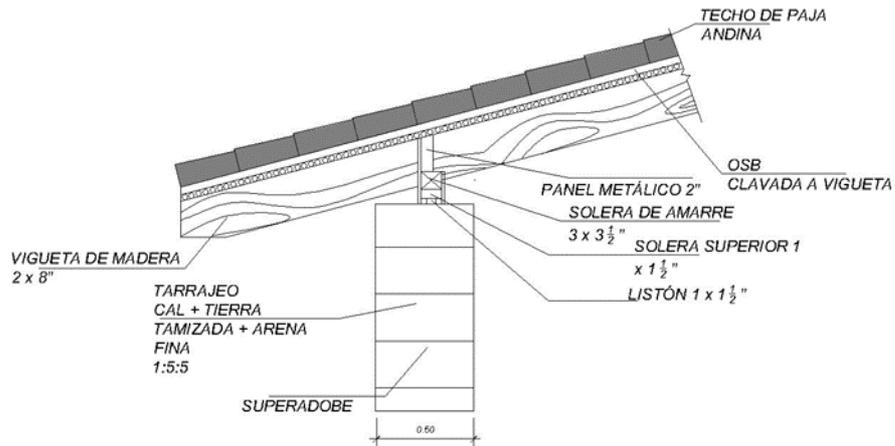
Detalle de Cubierta (Modelo con Súper Adobe).
